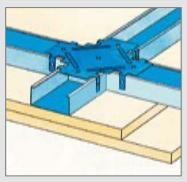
Disposition particulière pour plafond C.F.2H avec 2 plaques Fireboard FB 15 profilés CD 60, entretoises et connecteurs en croix
